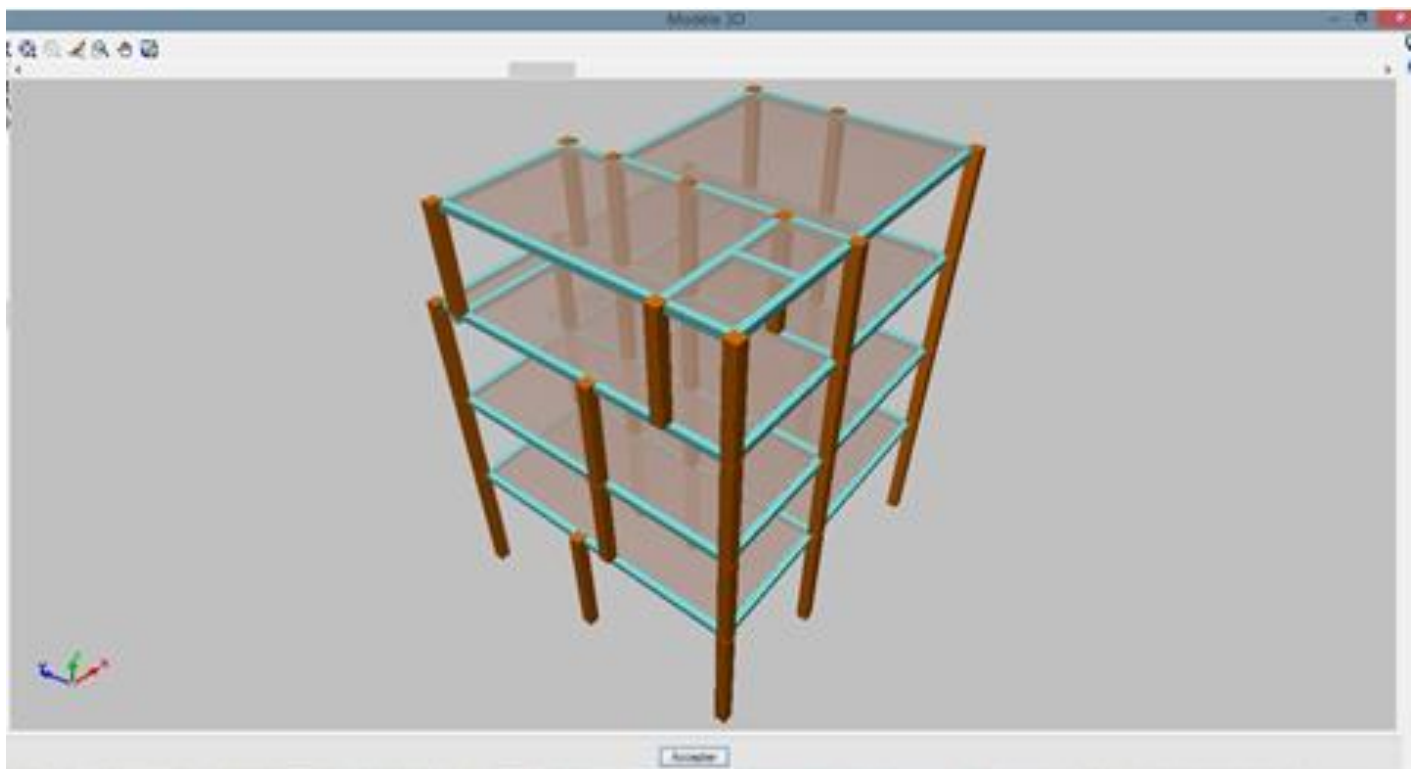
MODELISATION DE LA VARIANTE EN DALLE ALVEOLEE SUR CYPECAD
